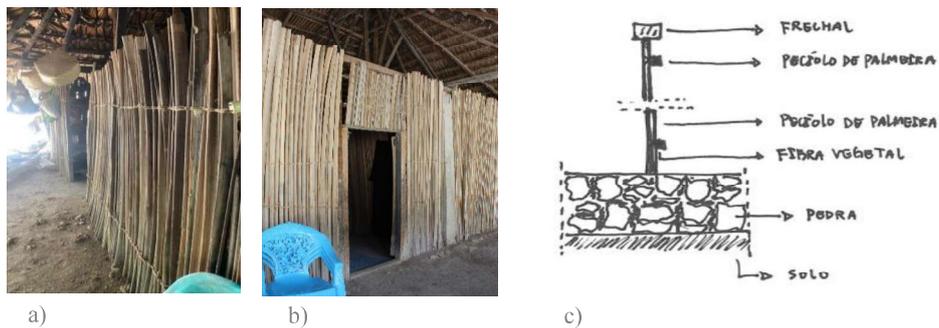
34. Parede de palmeira. a) e b) Paredes de palapa assentam diretamente no pavimento de terra batida. c) Desenho em corte da parede.
